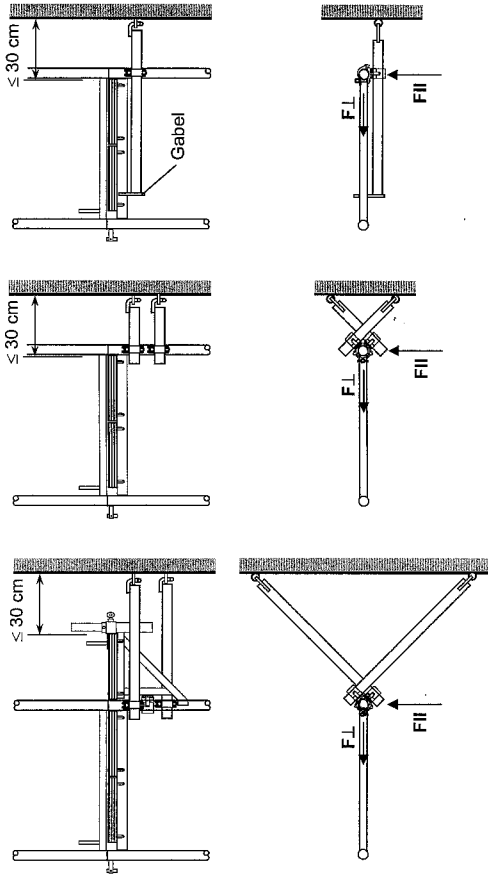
Höhenlage der Gerüsthalter bei Anschluss im „Knoten“.
